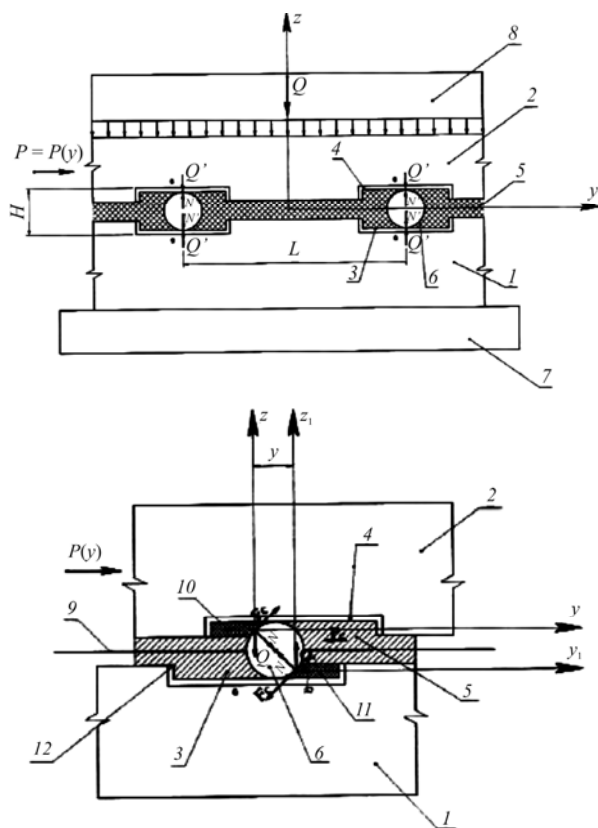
Конструкция кинематического пояса: 1 — нижний пояс; 2 — верхний пояс; 3 — стакан; 4 — закладная деталь; 5 — изоляционный материал; 6 — подвижной элемент (шарообразной или цилиндрической формы); 7 — фундамент здания; 8 — надпорная часть здания; 9 — плоскость сдвигового разрушения изоляционного слоя; 10, 11 — активные зоны изоляционного материала; 12 — выступ
